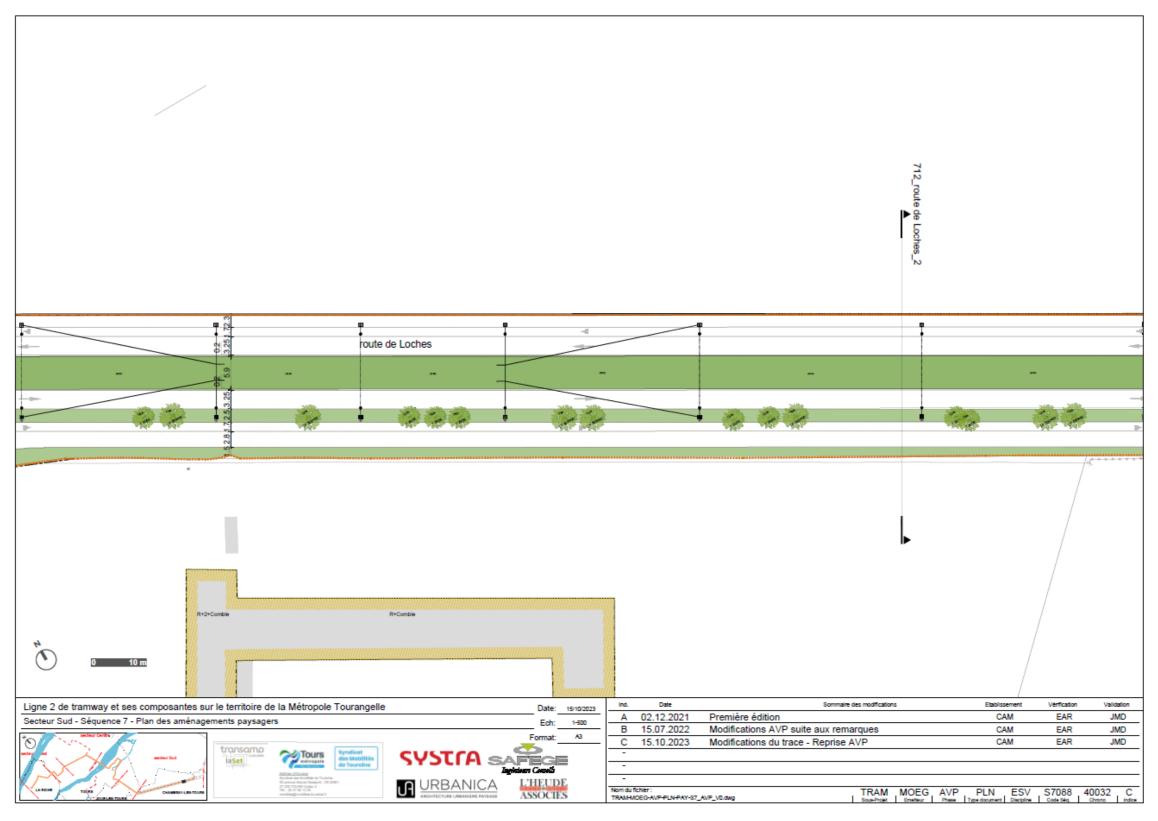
plan masse de localisation des arbres à abattre sur route de Loches (planche 16)
